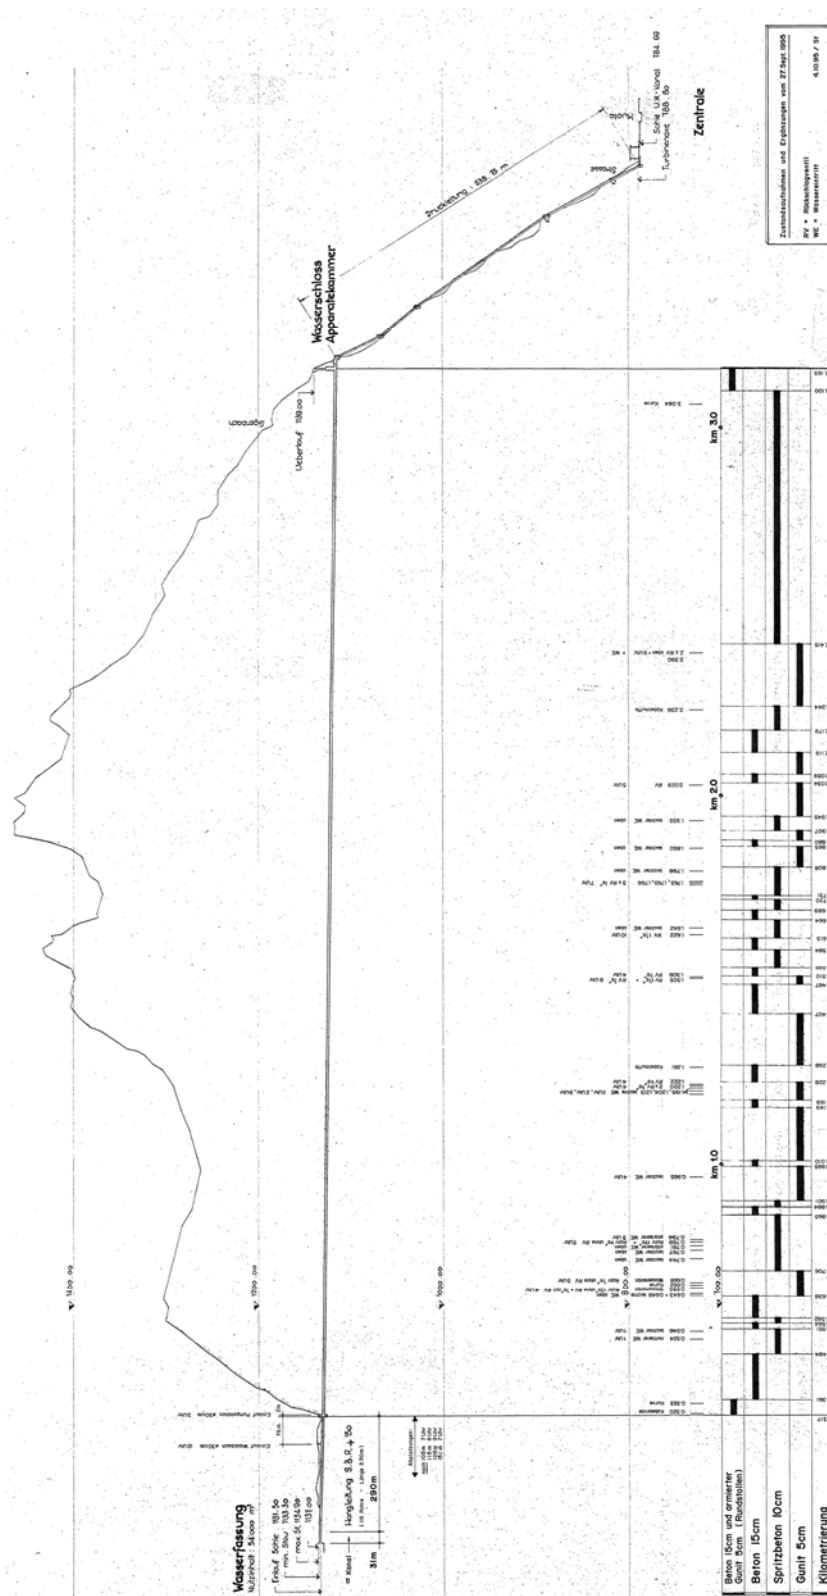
Längenprofil des bestehenden Triebwassersystems (Ausschnitt Plan Nr. 400-2).
